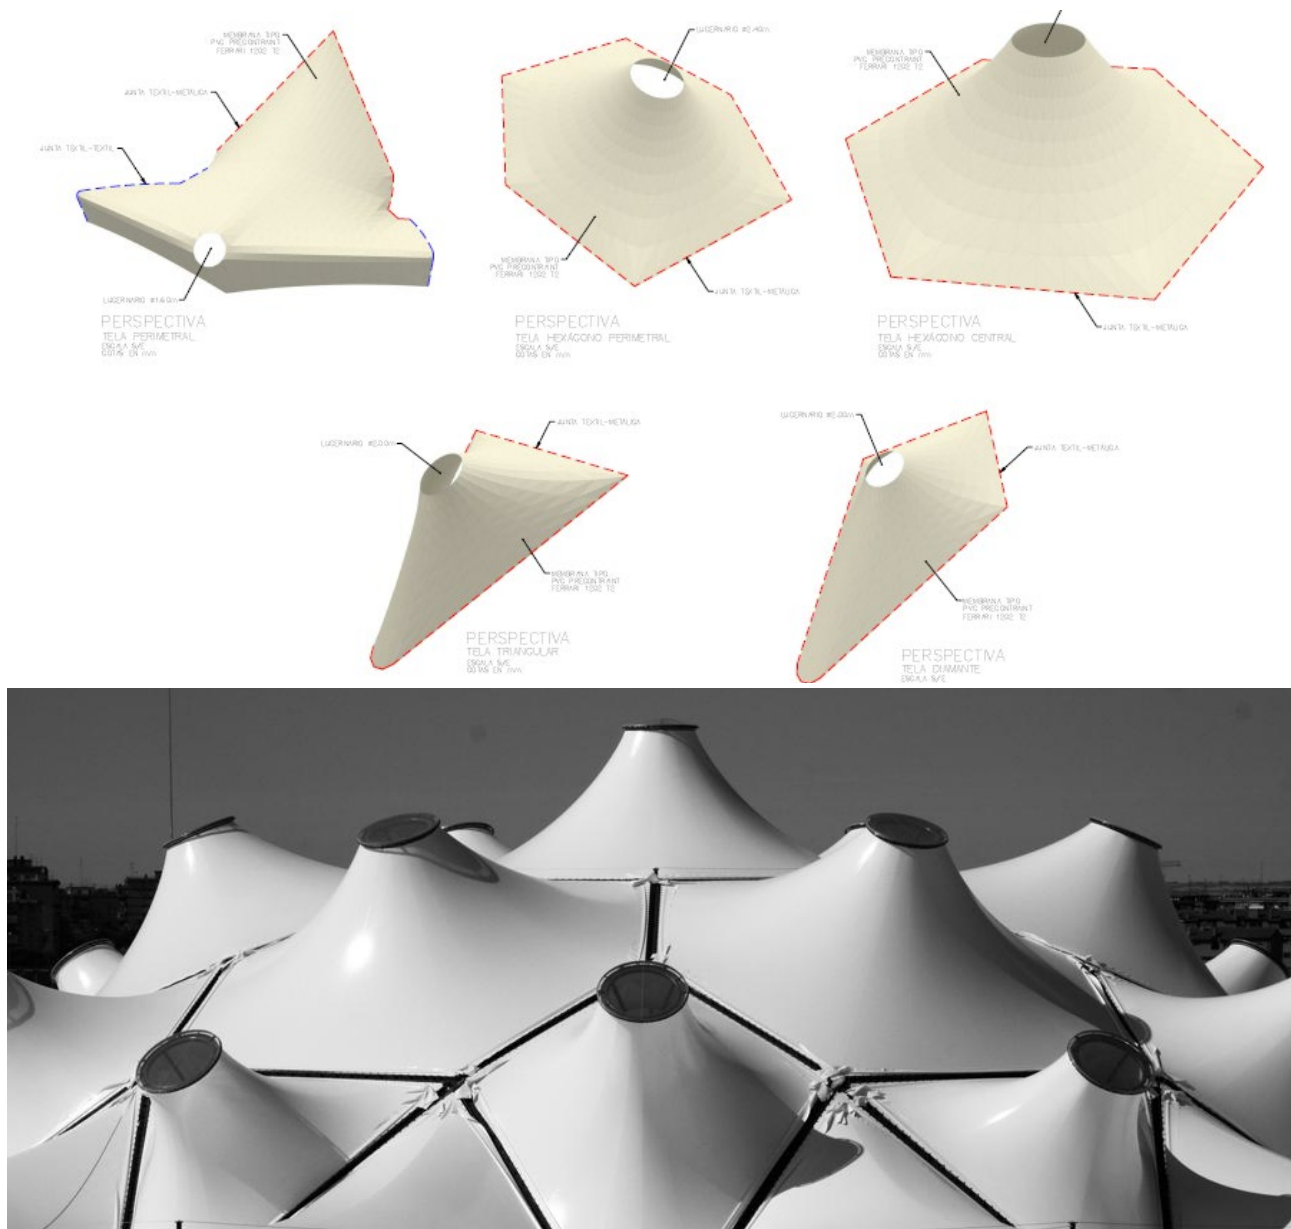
Tipologías de membrana aplicadas y vista superior de la cubierta.
